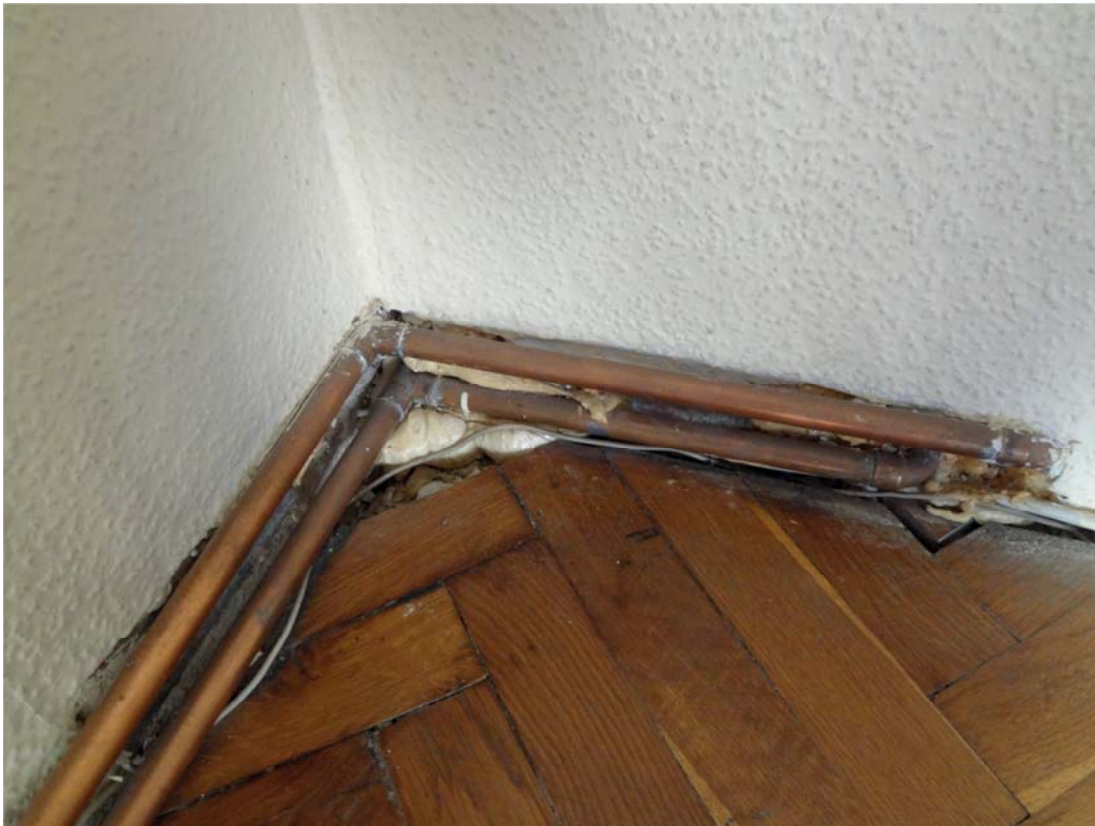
Aufputzinstallation im ersten Obergeschoß vor der Sanierung
